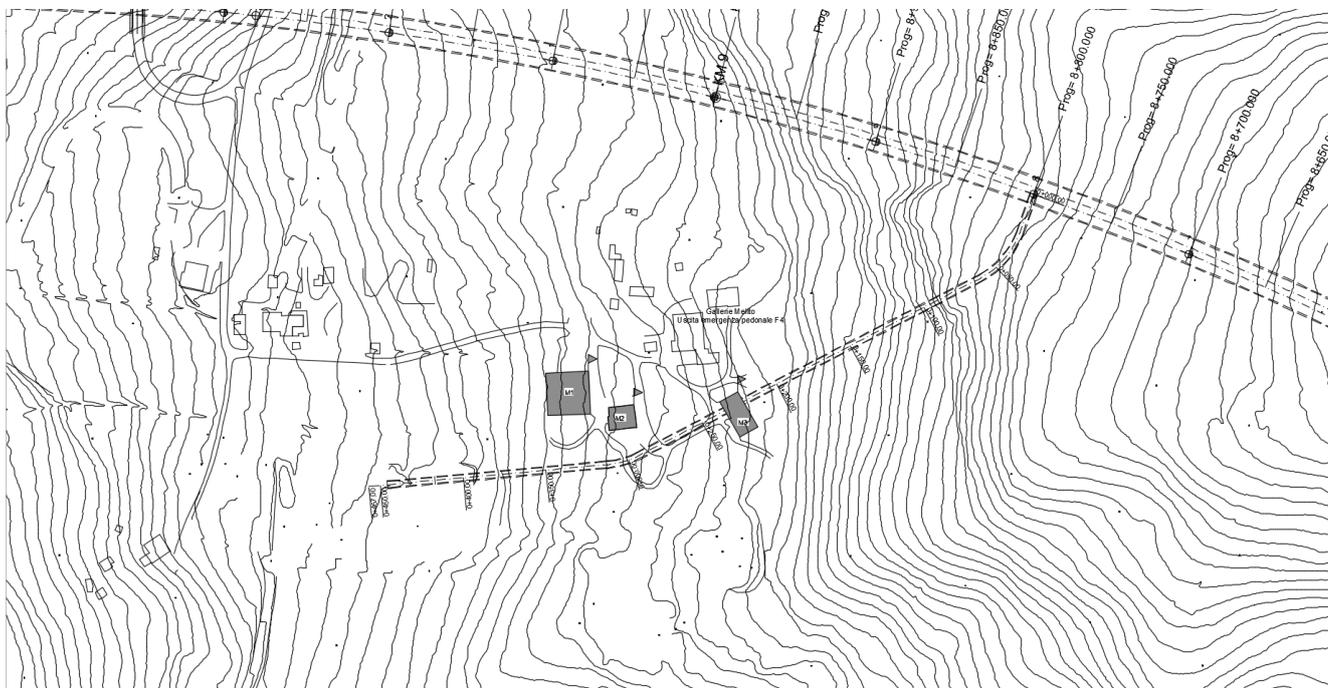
Planimetria posizione edifici zona galleria galleria Melito - Finestra F4
